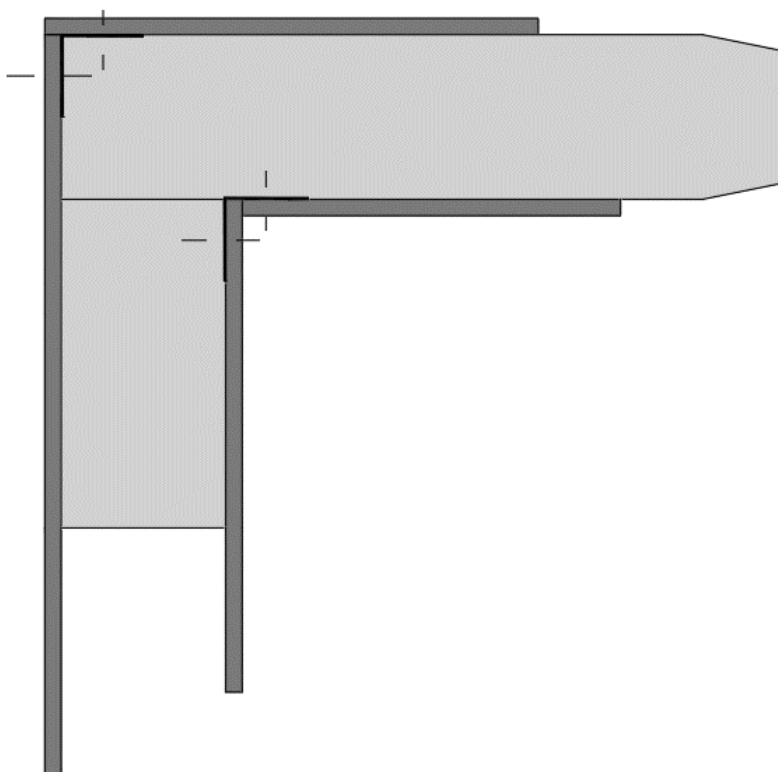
Vista em planta de ligação de canto dos painéis sandwich.
